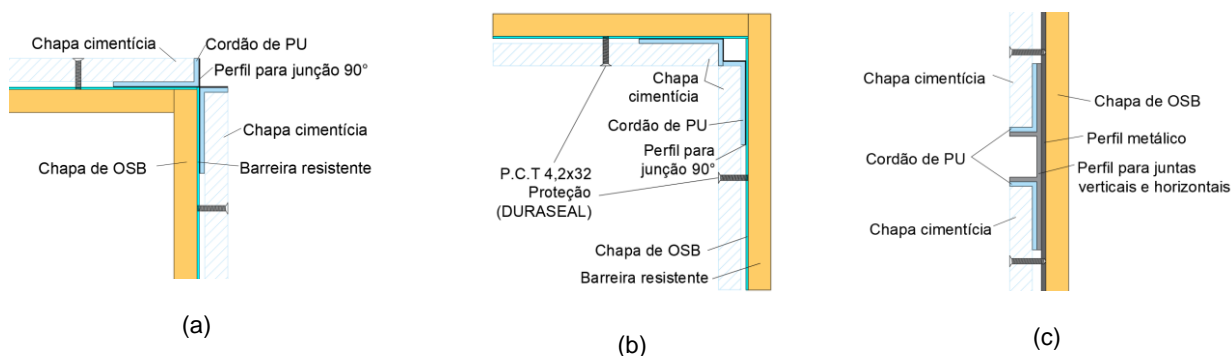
Detalhamento da interface de fixação entre painéis de parede (esquema em Planta, sem escala)
